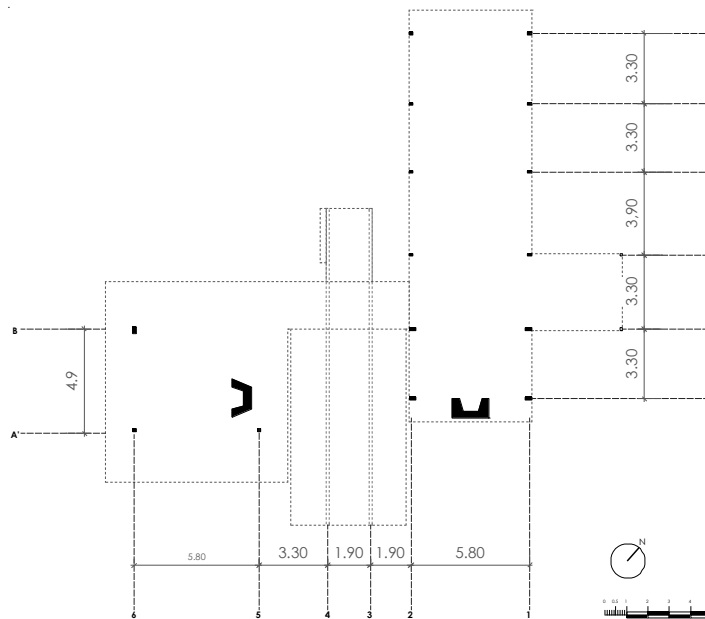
Esquema gráfico de la modulación estructural en planta baja. Fuente: Autor.
